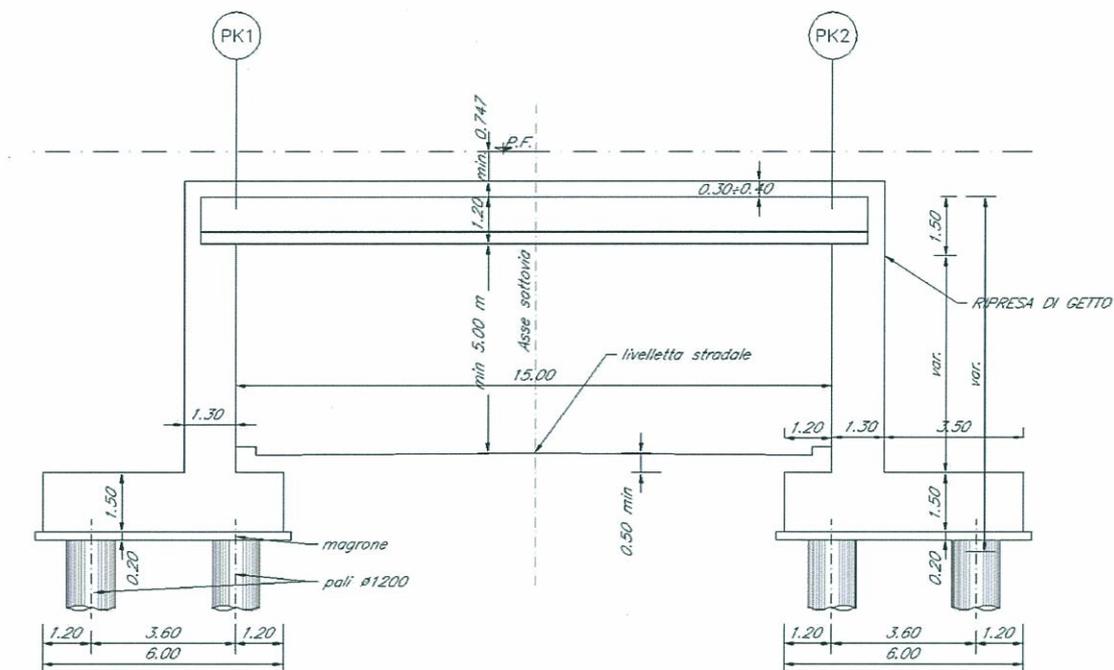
Prospetto in corrispondenza di attraversamento stradale.
